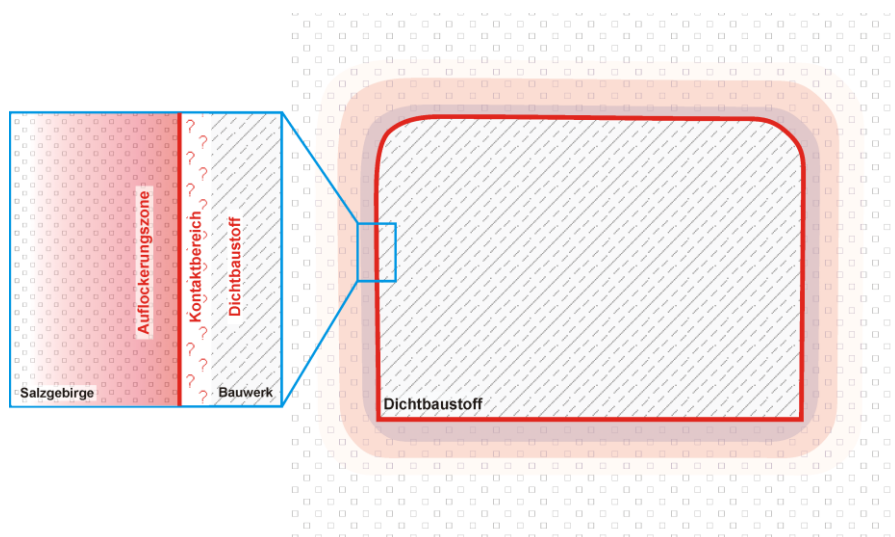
Schematische Darstellung Streckenverschlussbauwerk mit Details zum Kontakt Baustoff/Gebirge
